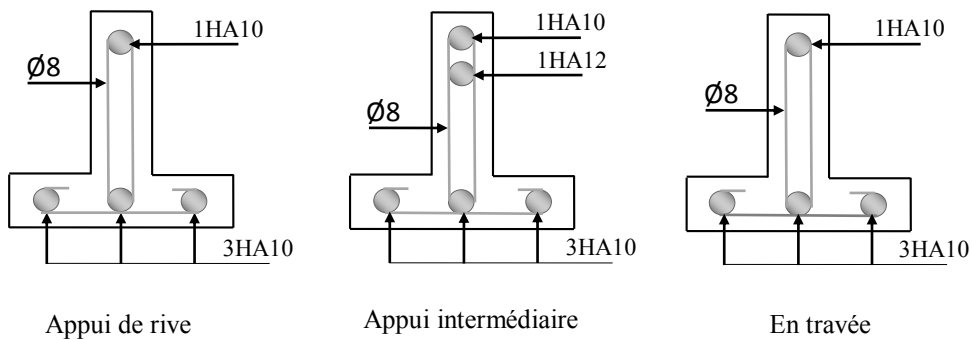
Ferrailage des poutrelles au plancher terrasse
